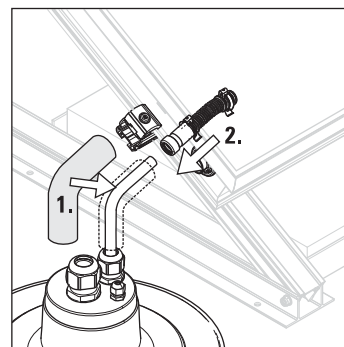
Anschlussfitting auf Anschlüsse stecken
